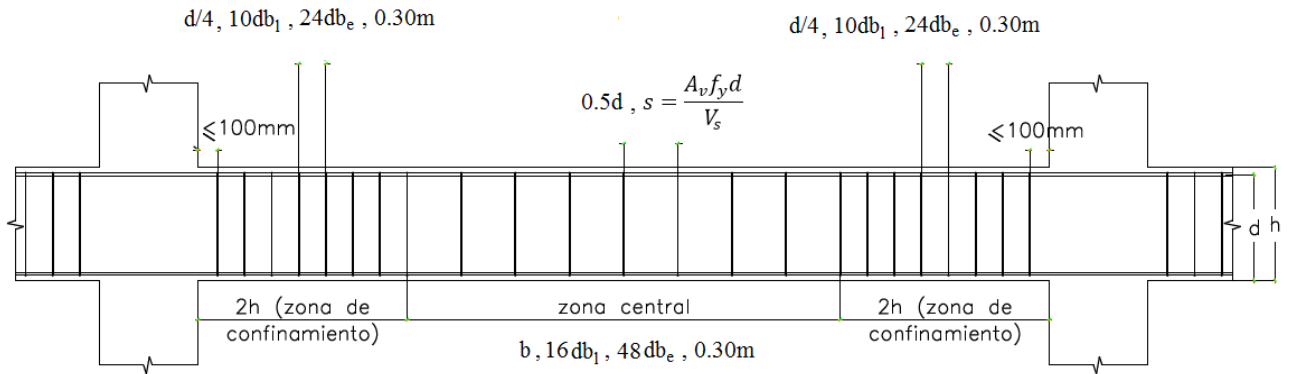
Requerimientos de vigas con sistema resistente a fuerzas laterales de muros estructurales
